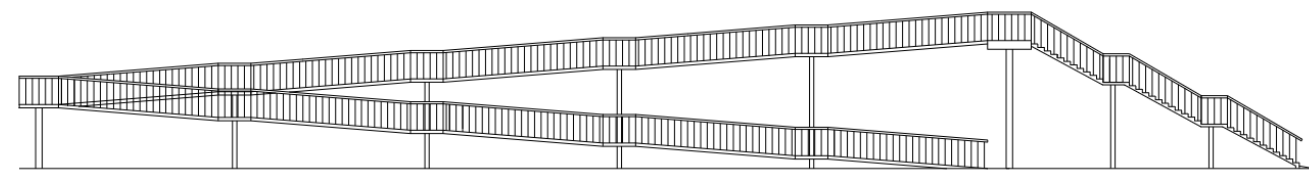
Alzado rampa y escaleras; Fuente: Elaboración propia
